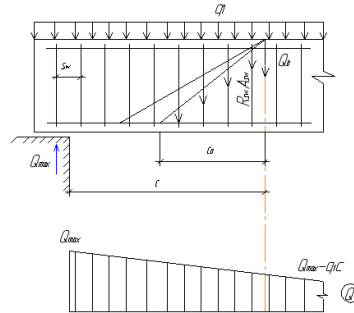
Схема усилий в наклонном сечении элемента, армированного хомутами, при расчёте на действие поперечной силы.
